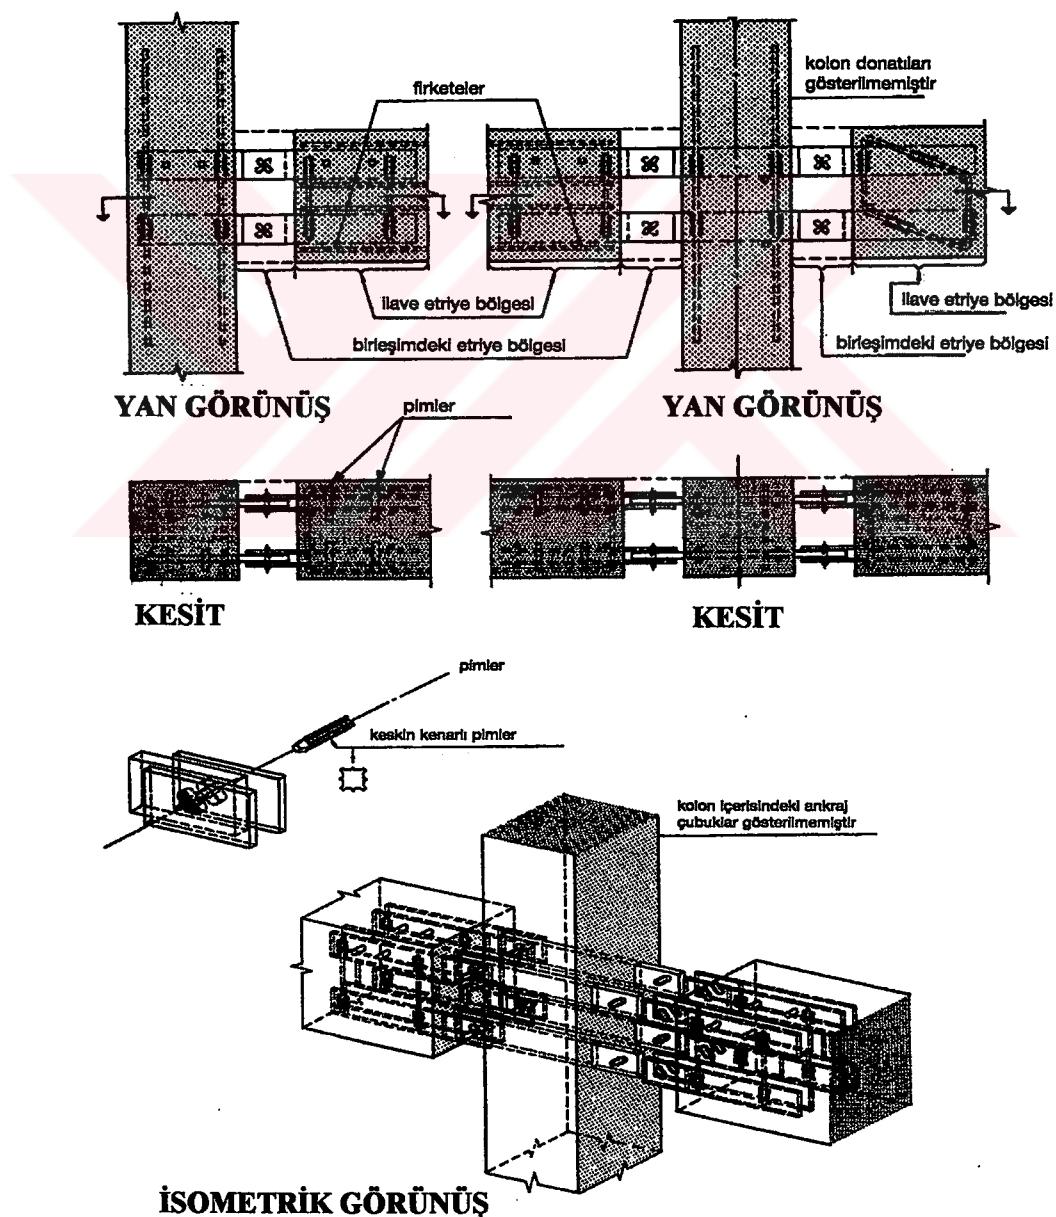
Kirişteki yerinde dökme betonla kolon-kiriş birleşimi
